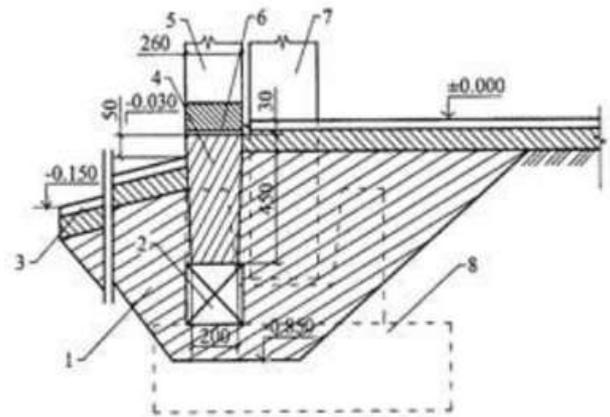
Збірні залізобетонні фундаменти під колони:
